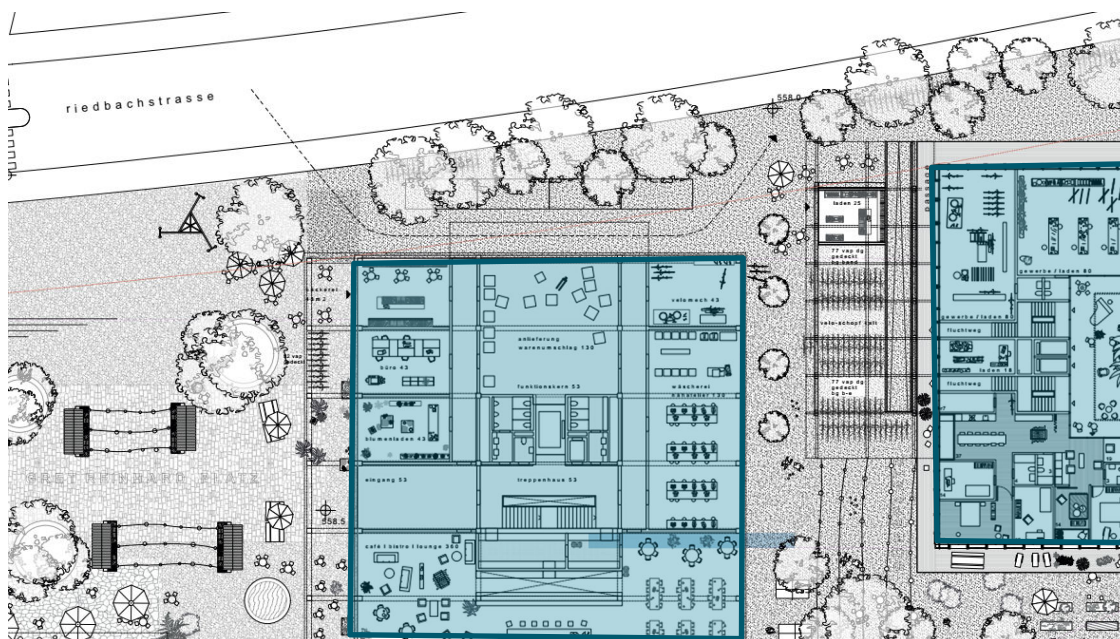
Sockelgeschosse vom «Band» Gebäude und vom «Brunnen Eichholz» Gebäude mit Dienstleistungsbetrieben [Planungsteam, Ausschnitt Situation, Stand 08.06.2022]
